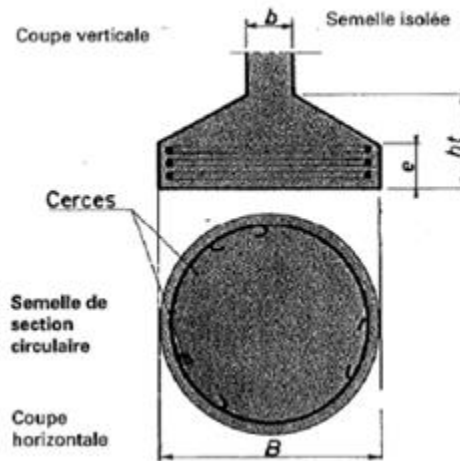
Disposition des aciers dans une semelle isolée circulaire
